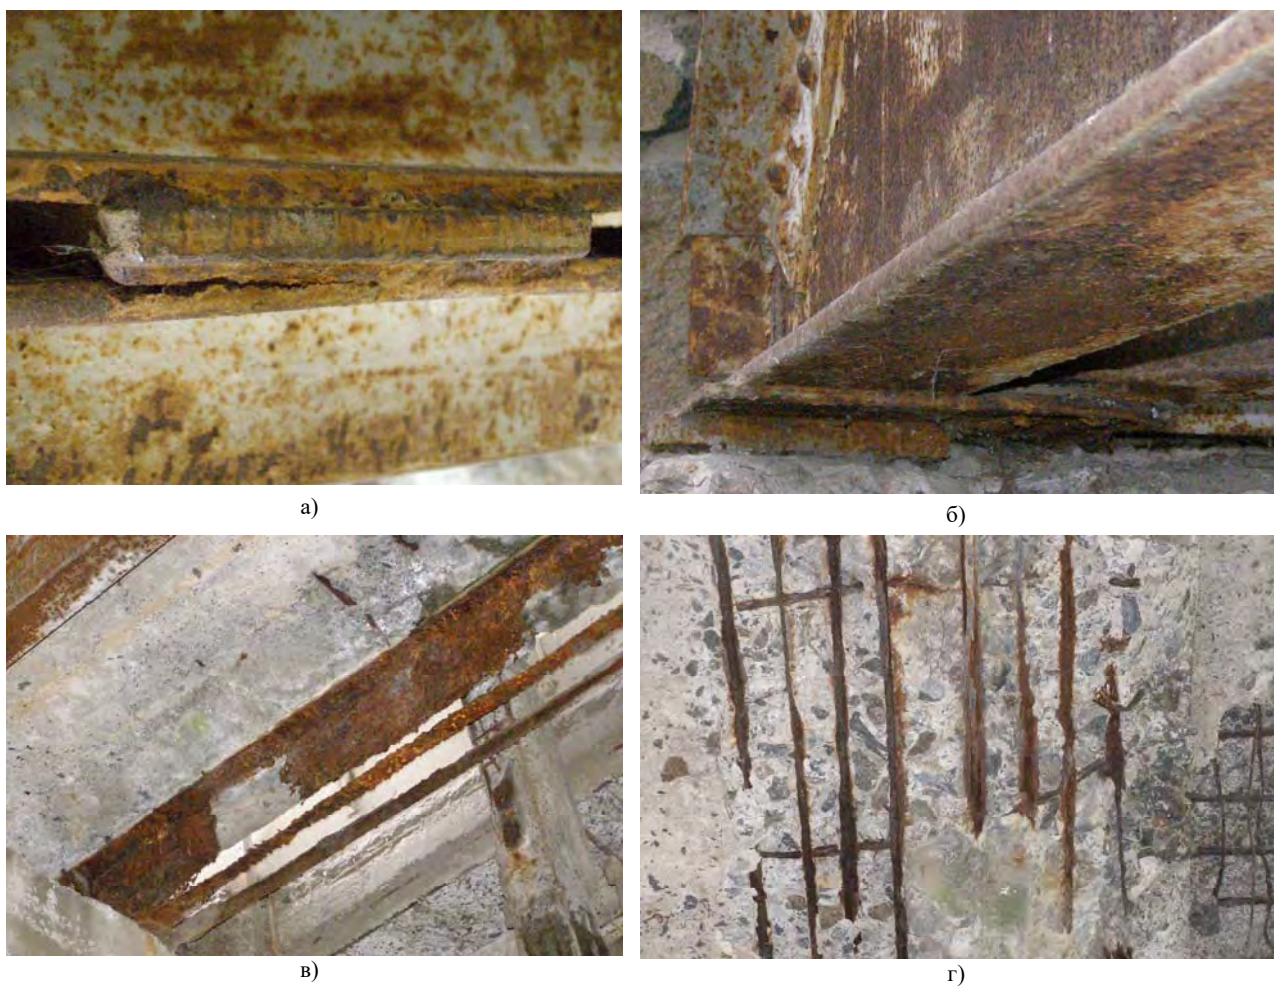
Типові дефекти конструктивних елементів сталобетонних мостів: а – тріщини в металі та зварних швах, б – викривлення, поверхнева та шарувата корозія опорних конструкцій, в – наскрізне руйнування металу, г – руйнування захисного шару з корозією робочого армування.
